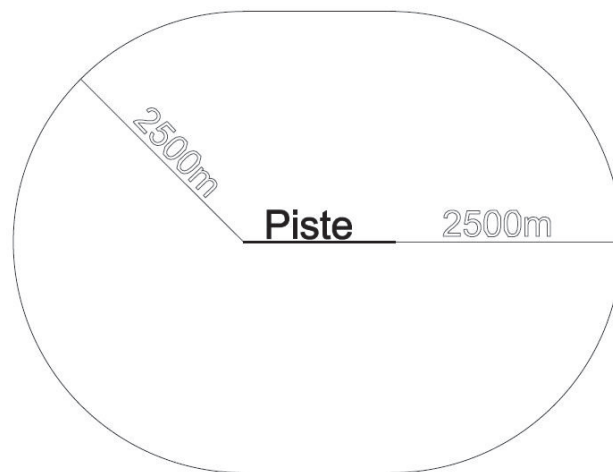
VUE EN PLAN DE LA SURFACE HORIZONTALE INTERIEURE
